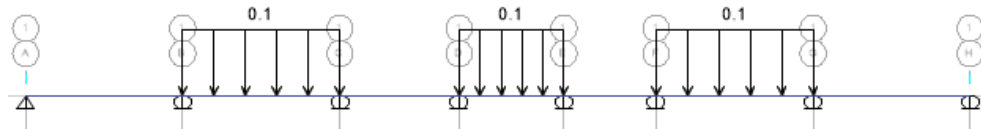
Carga viva distribuida en vigueta de losa aligerada – Damero 2
